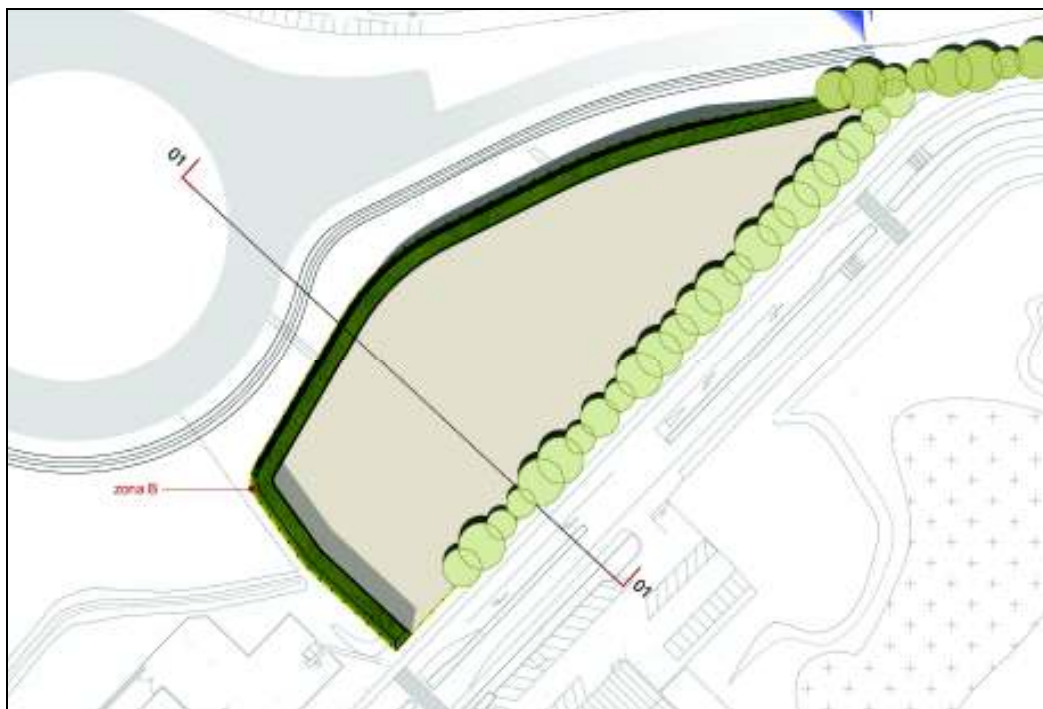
Planimetria generale dello stato di progetto. Prima fase, con costruzione del rilevato in terra di riporto.
